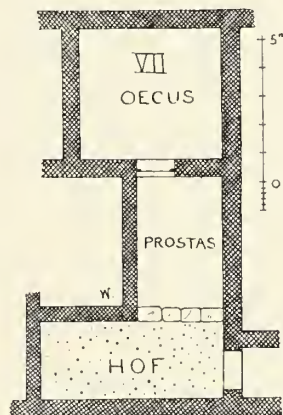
Grundriss des Hauses Nr. VII.
